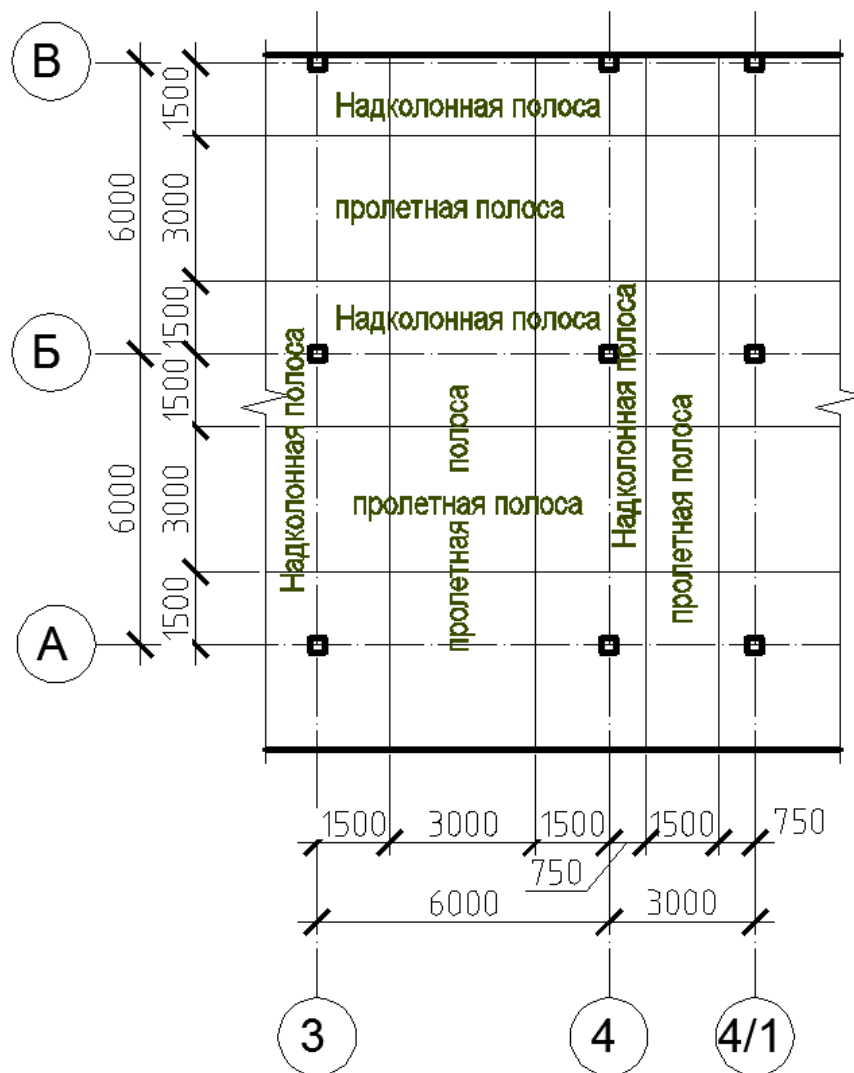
Разбивка безбалочного перекрытия на надколонные и пролетные полосы
